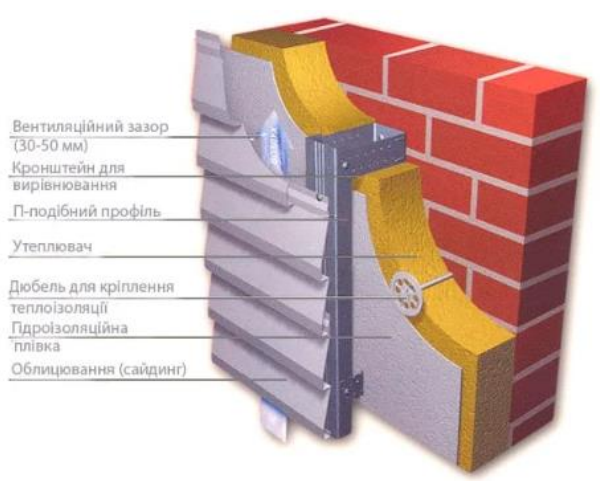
Устрій вентиляованого фасаду.
